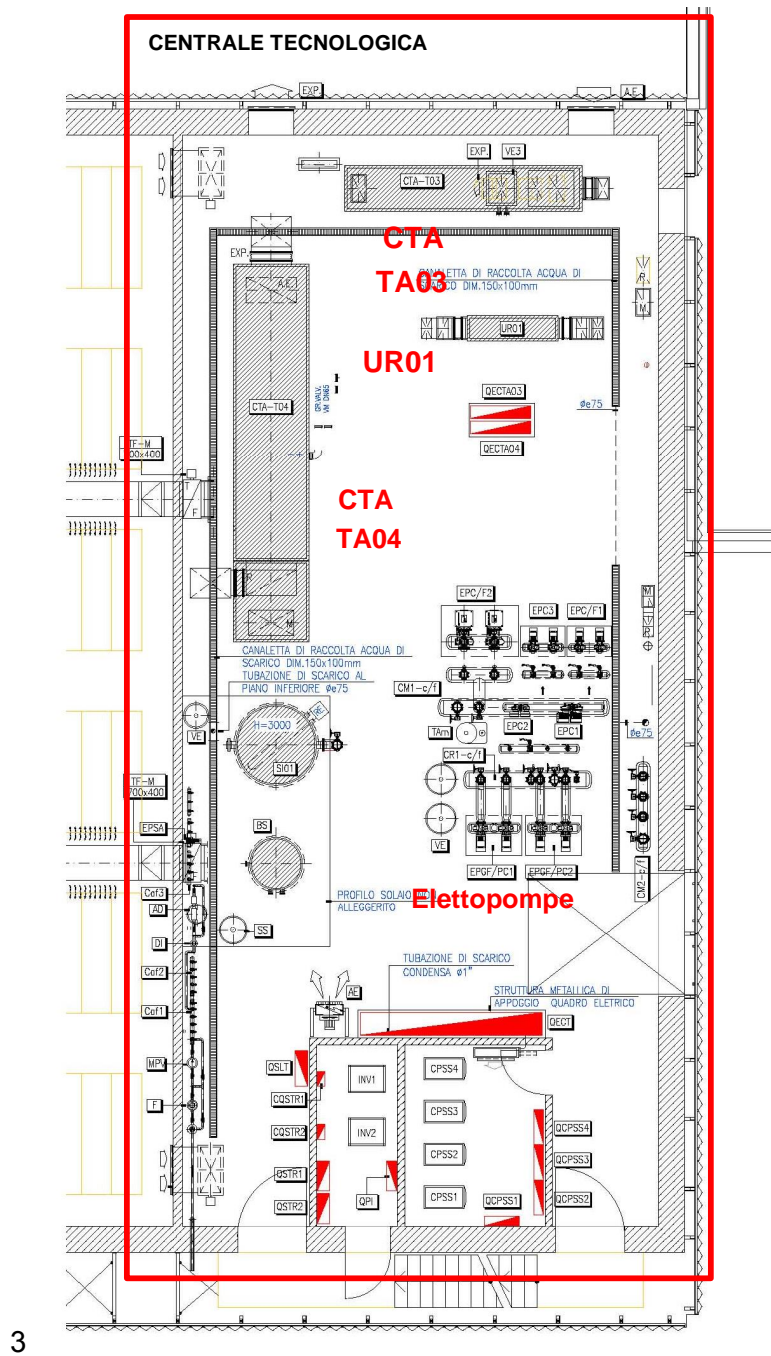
PALESTRA È centrale tecnologica al piano sopraelevato
